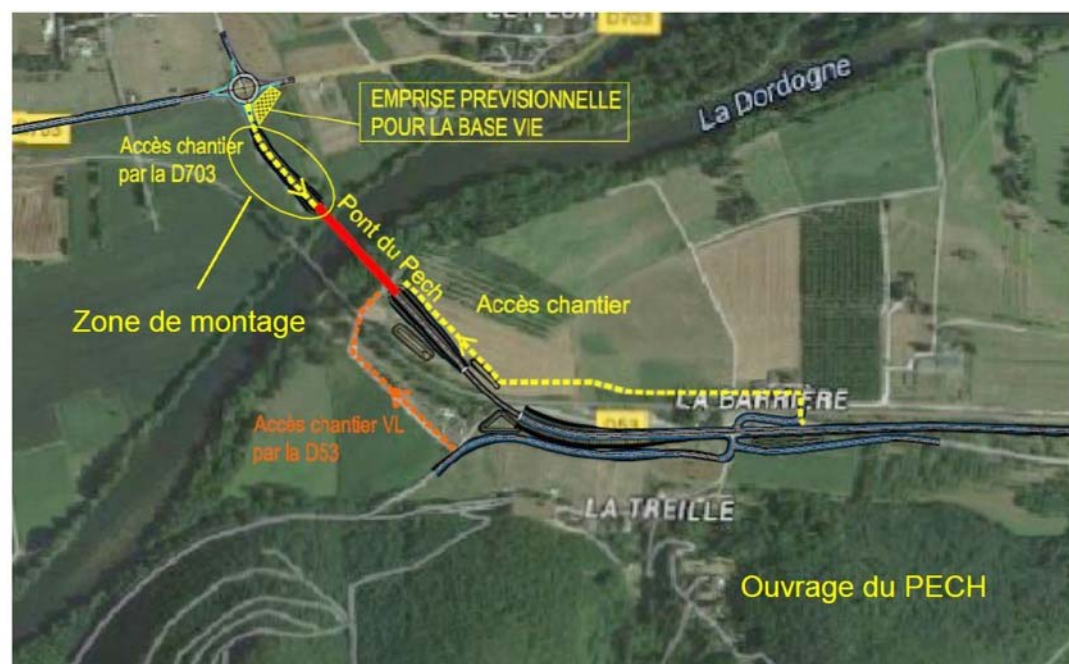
Plan d'implantation de la zone de montage et des accès chantier pour l'OA du Pech (Source : setec tpi, juillet 2016)
